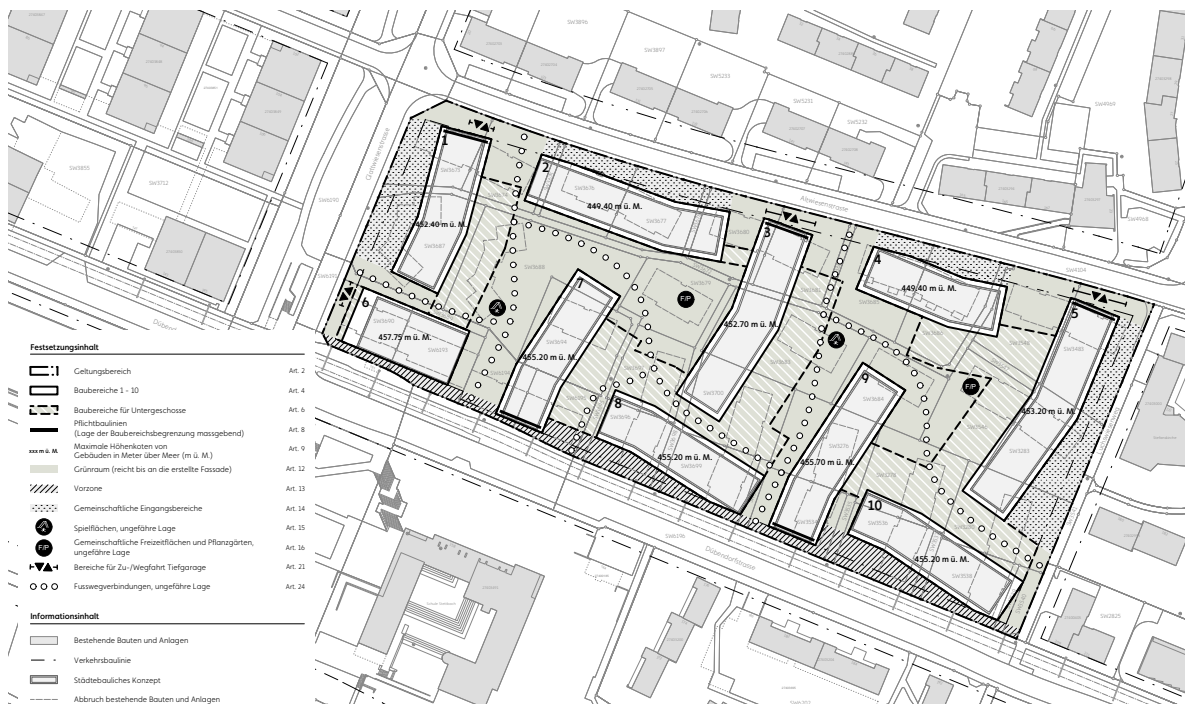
Ausschnitt Situationsplan (verkleinert, genordet)
